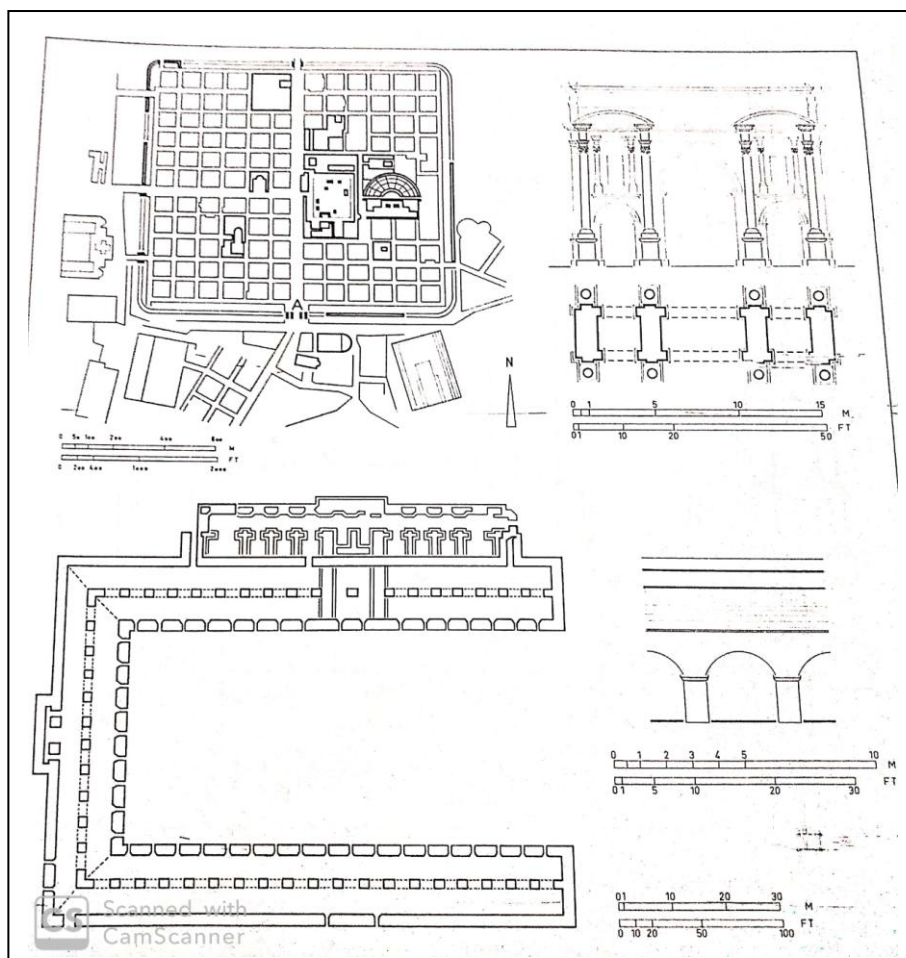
plan de la ville de Timgad, à droite élévation et plan de l'arc de Trajan, en bas cryptoportique
